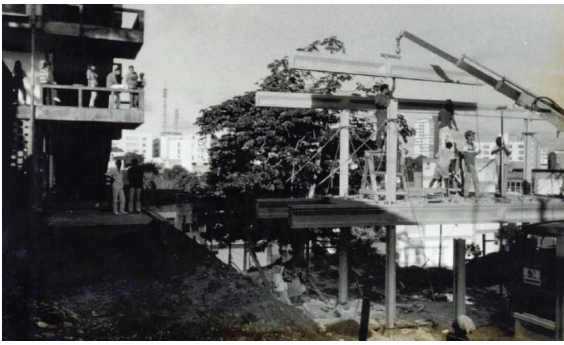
| Módulo do PPGAU. Montagem das peças e fachada ao Sul
